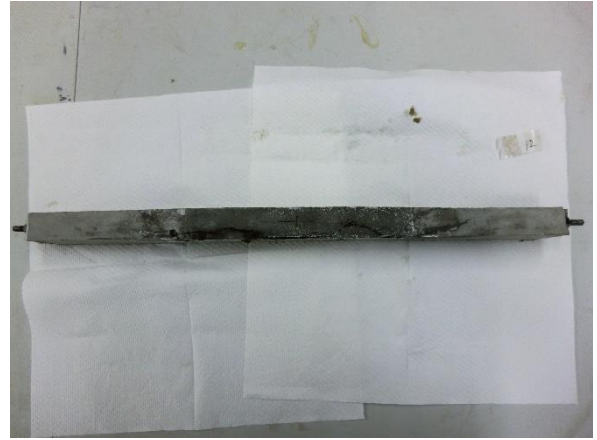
No.XIIの腐食ひび割れの様子
